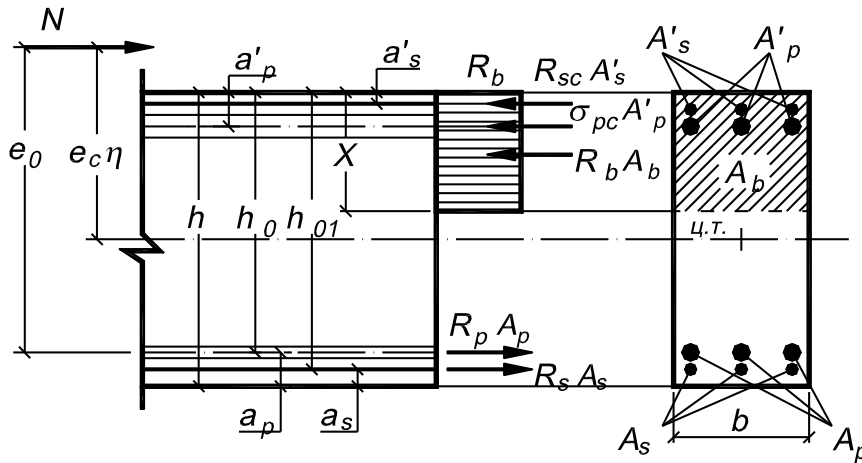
Схема зусиль і еюра напружень у перерізі, нормальному до поздовжньої осі позацентрово стиснутого залізобетонного елемента, при розрахунку його міцності
